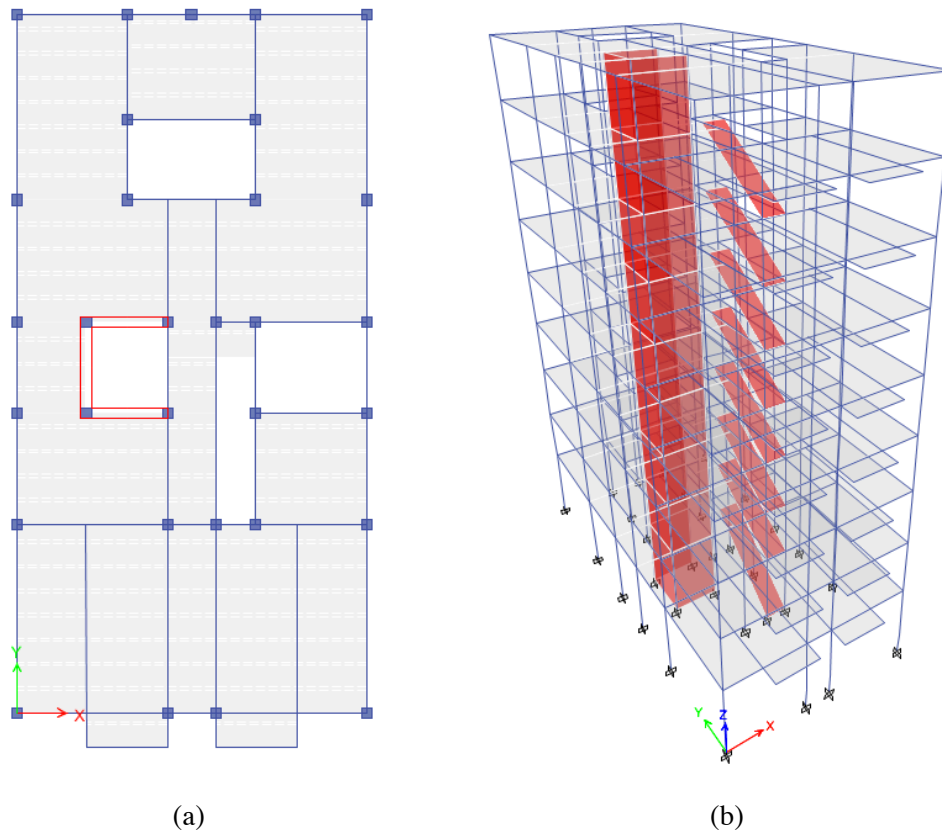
Edificio tipo 9U-S y 9U-C. (a) Planta. (b) Vista 3D
